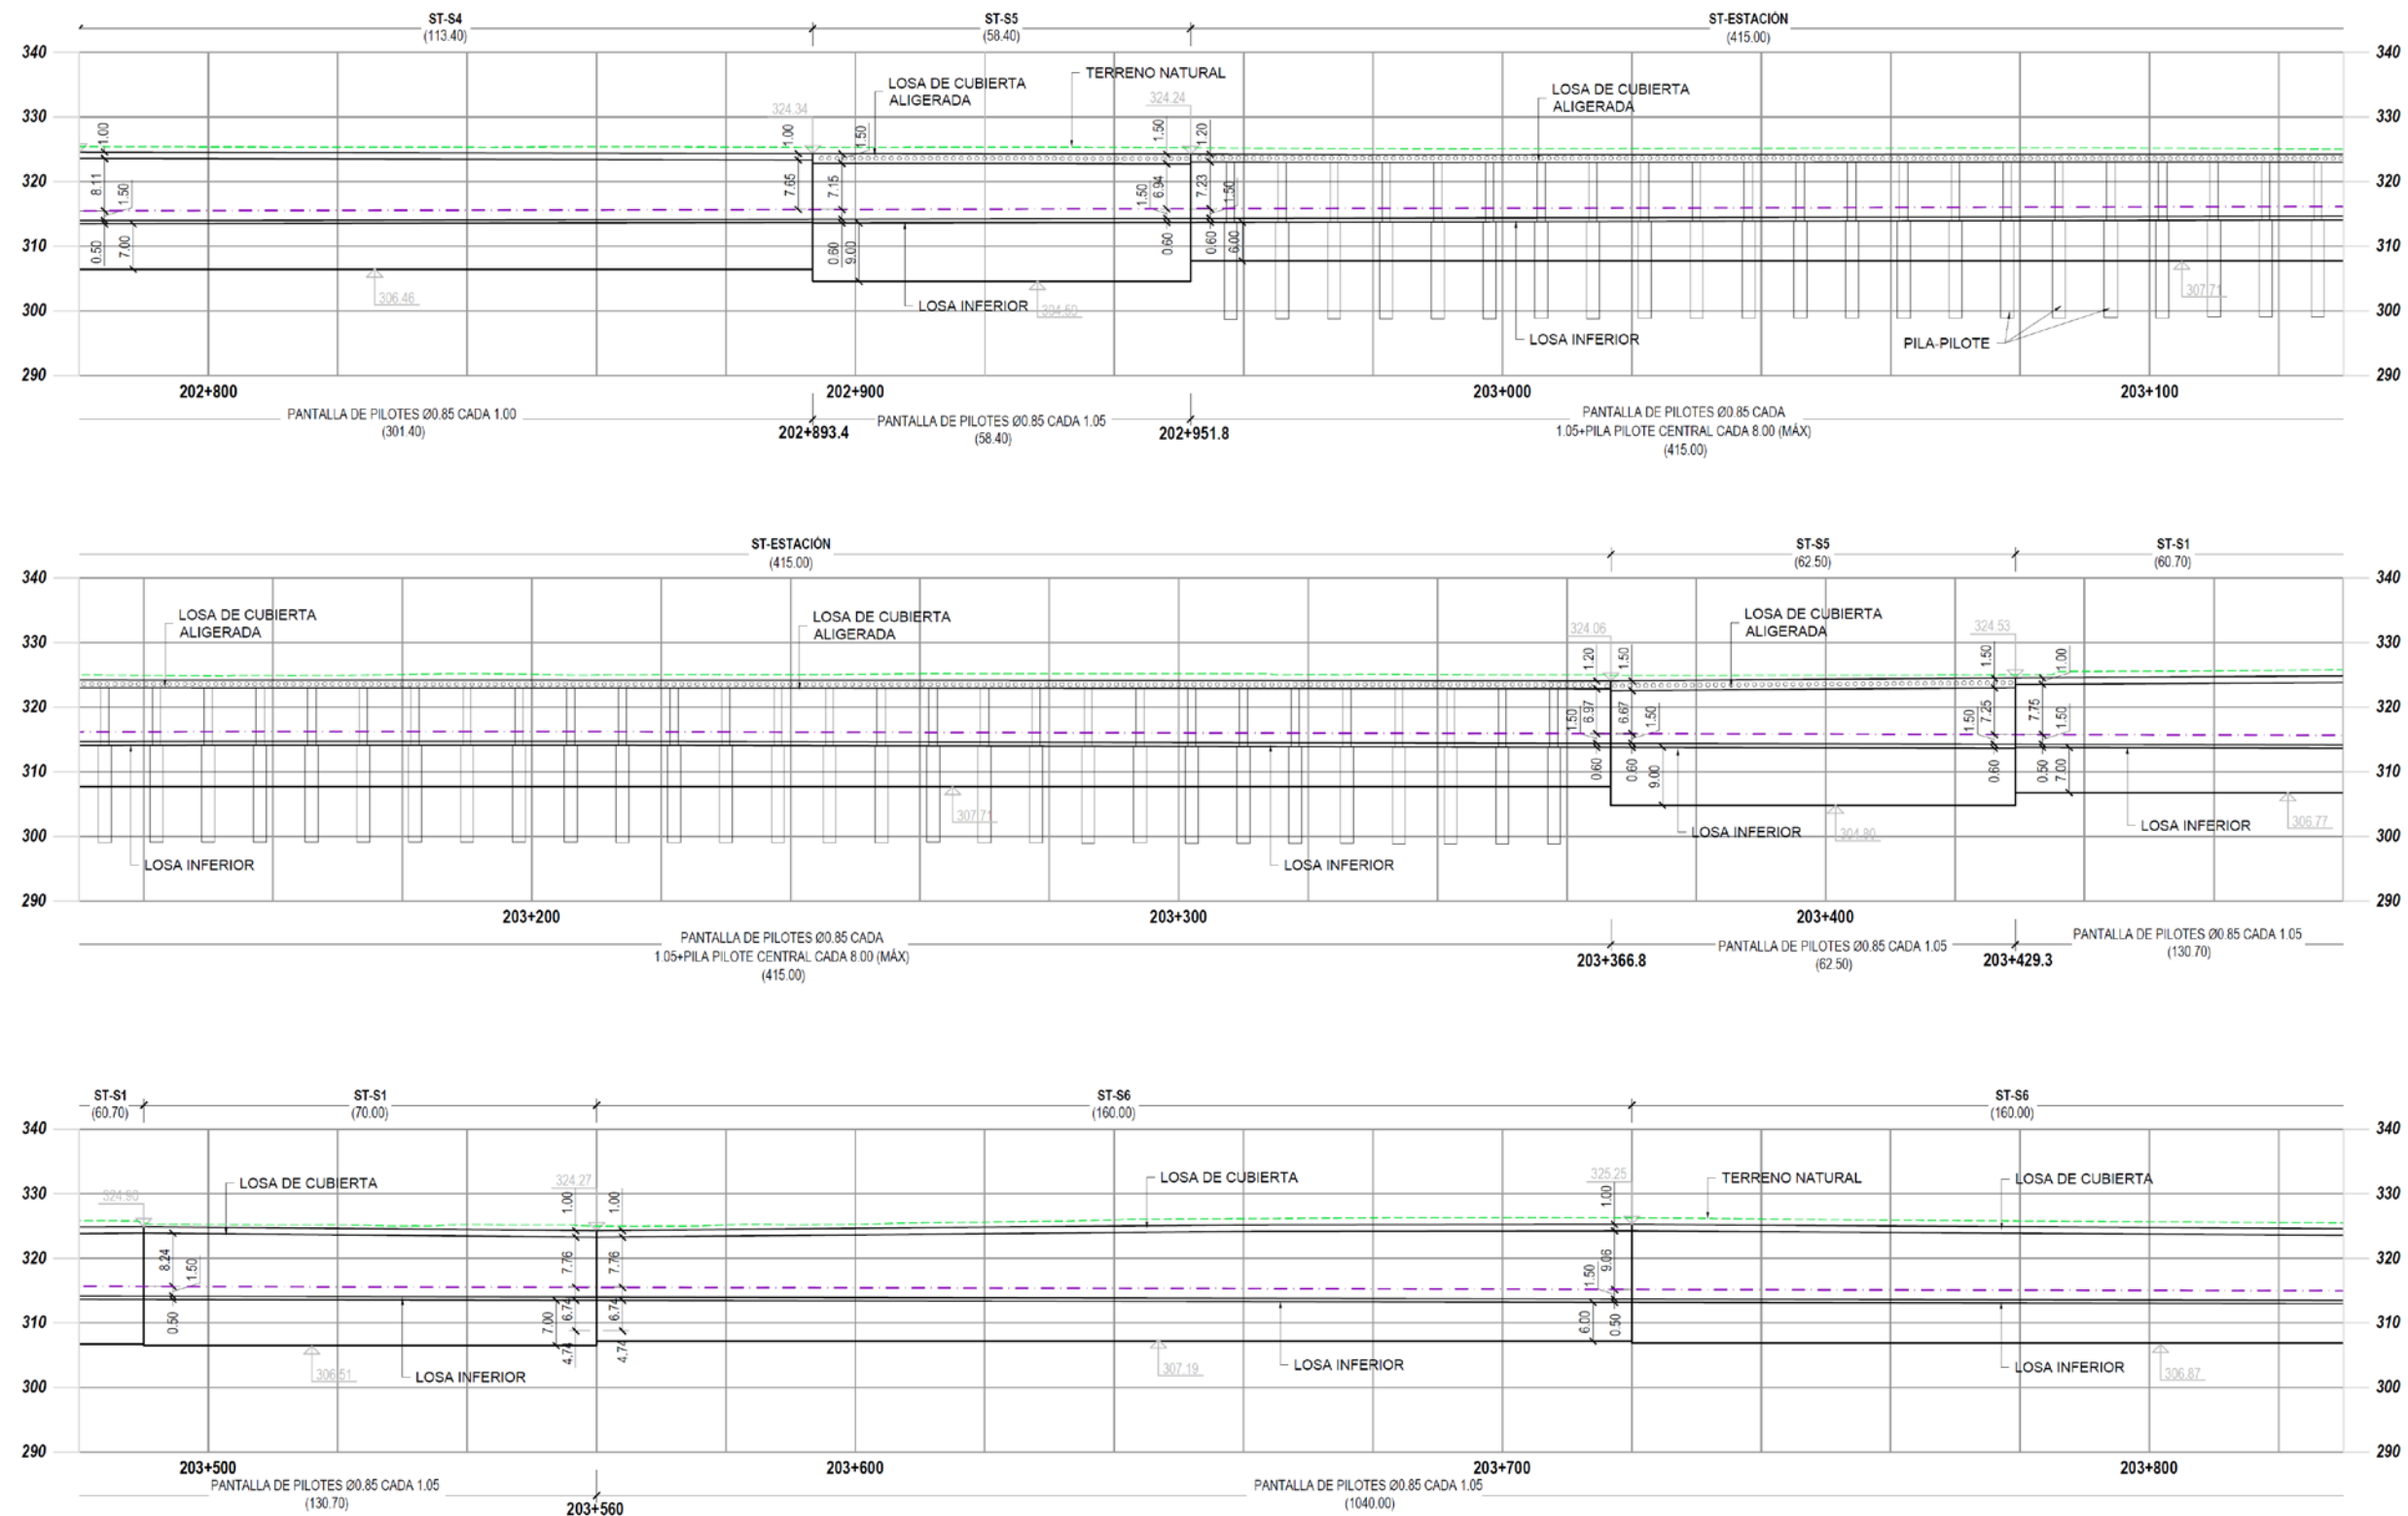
a.- Perfil longitudinal del tramo soterrado con indicación de las distintas soluciones constructivas (2 de 3).
